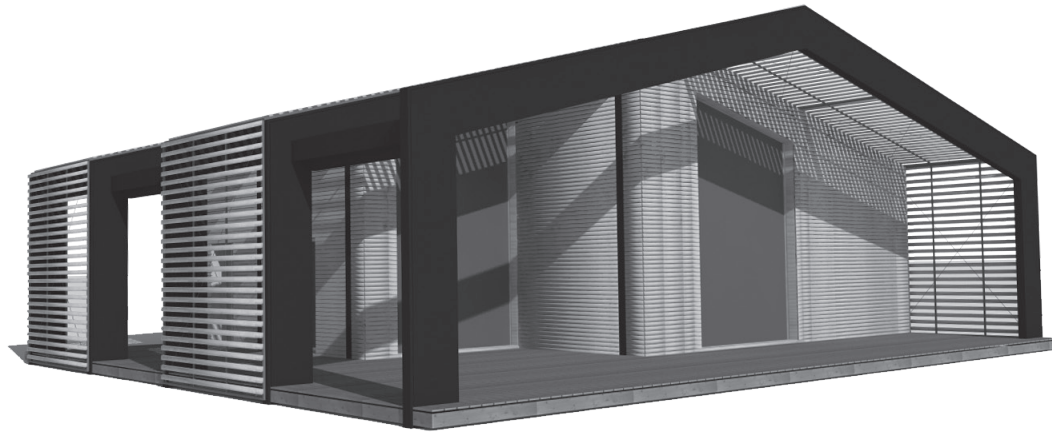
| Loft-Variante für Bauteilkatalog Südwestansicht
